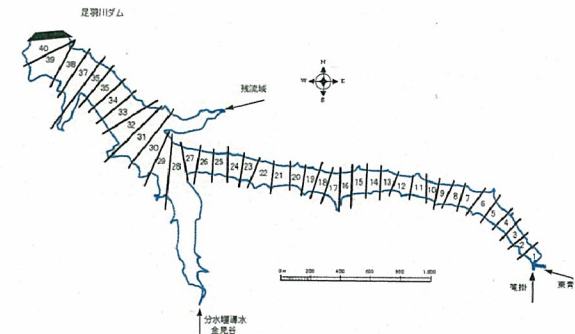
足羽川ダム洪水調節地の平面図
